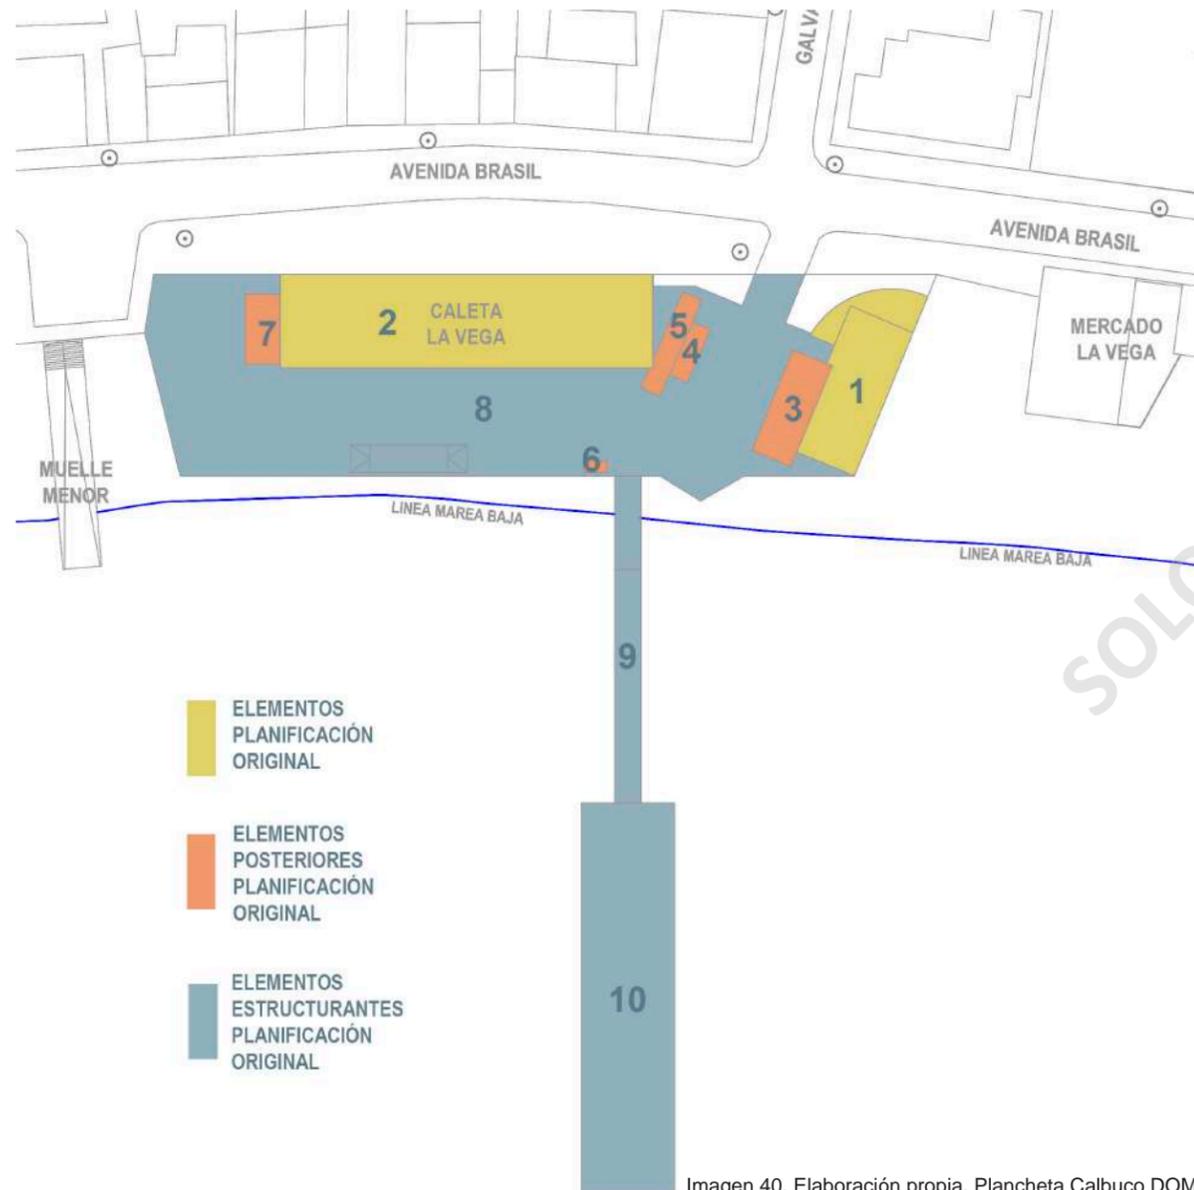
Elaboración propia. Plancheta Calbuco DOM.
